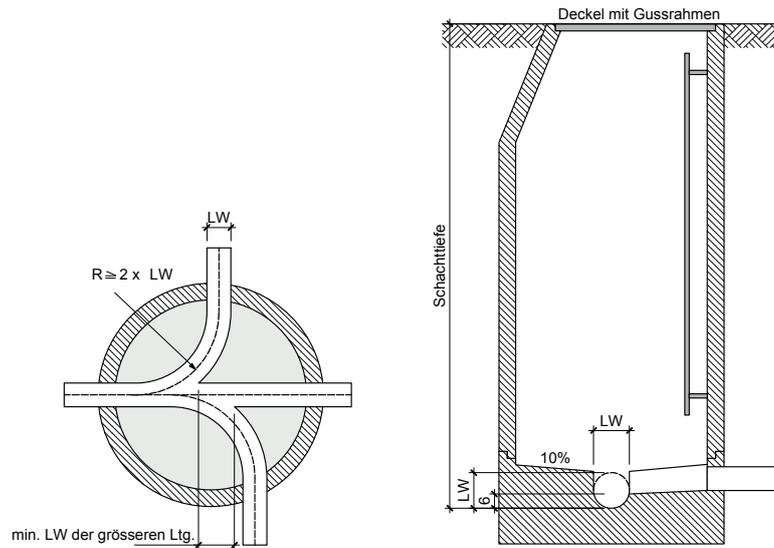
+27 Einstiegschacht (ES) im Grundriss und Schnitt
